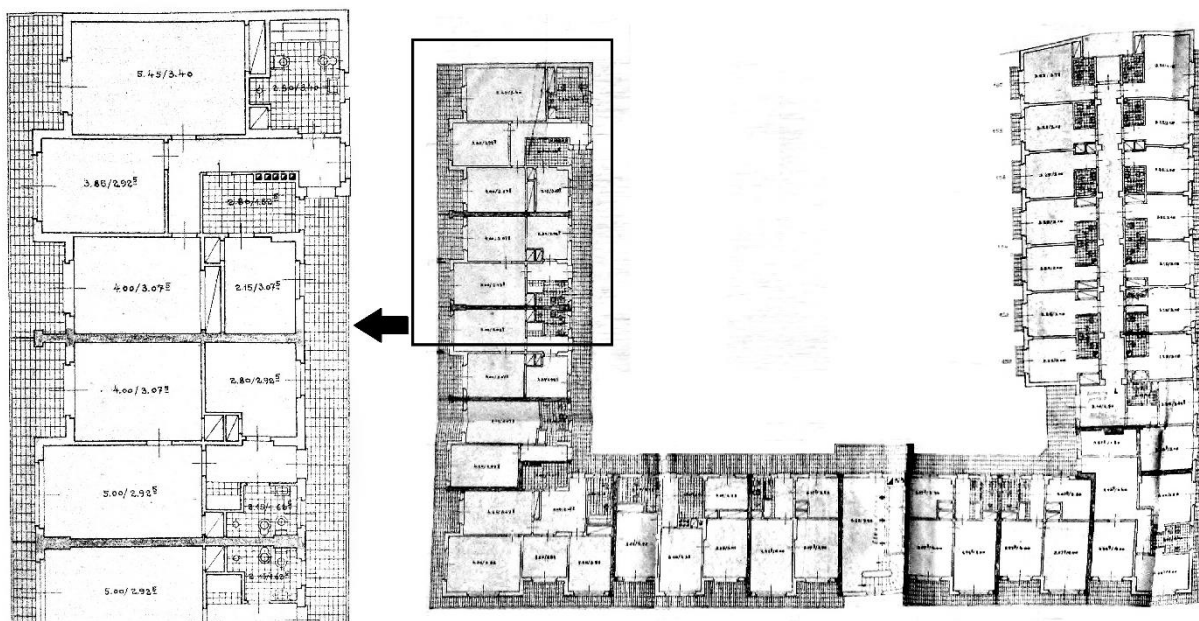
Planta baixa do pavimento tipo, com área residencial no “L” (leste e norte) e hotel na parte posterior da fachada oeste. Fonte: Museu Três Torres. Edição da autora.
